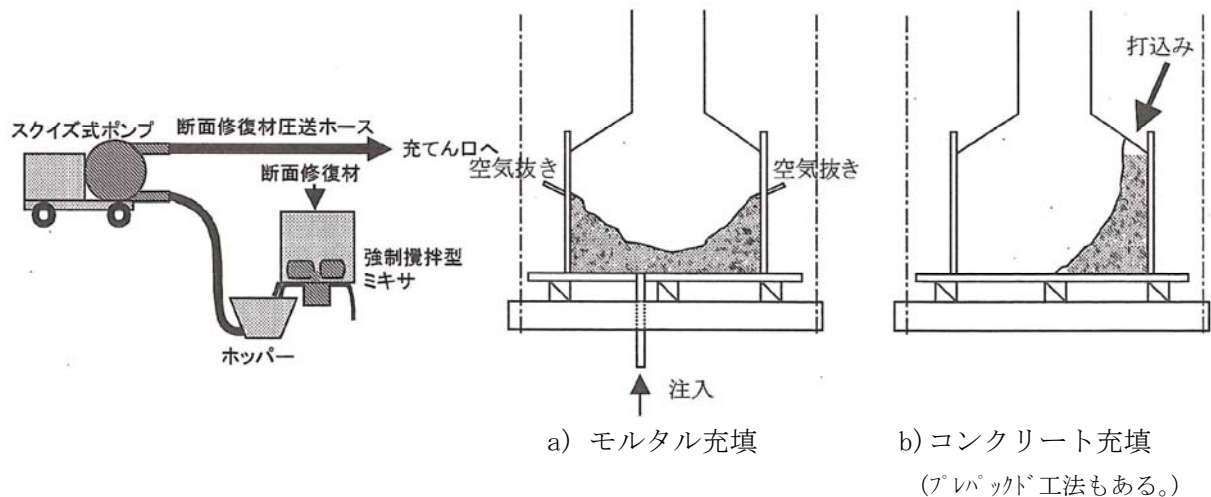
(4) 充填工法による断面修復の施工概念 (出典：「⑥設計施工指針 (案)」)
